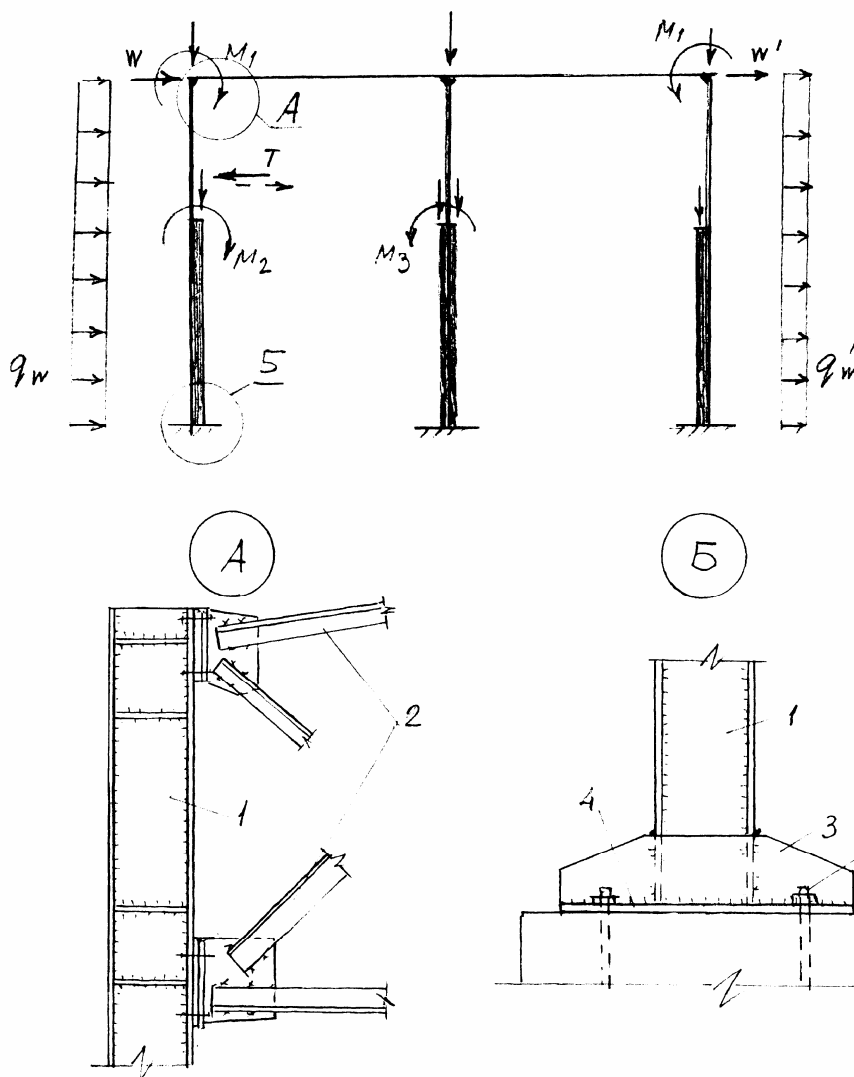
Розрахункова схема одноповерхової промислової будівлі з металевим каркасом:
